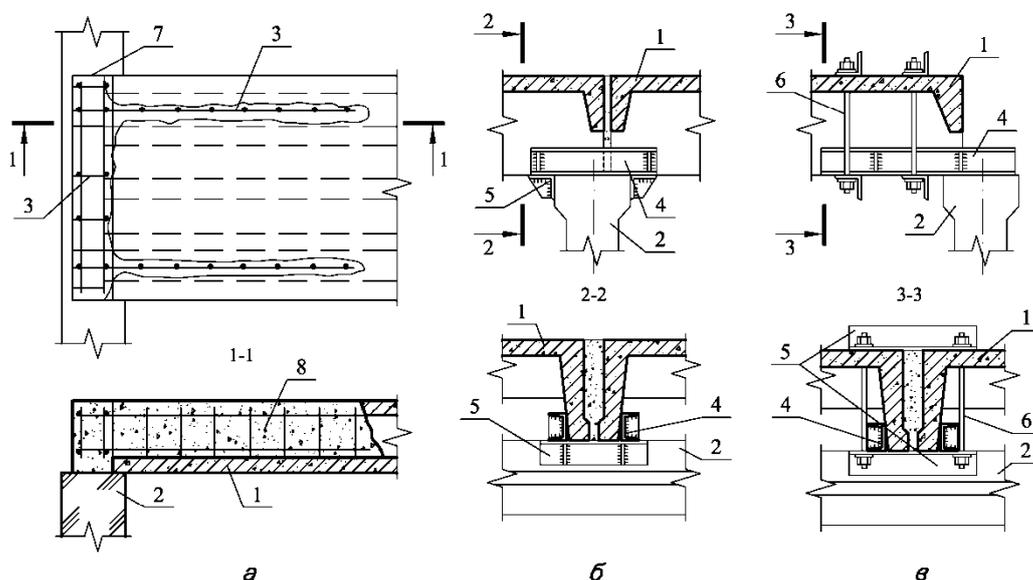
Усиление сборных железобетонных плит при недостаточном опирании: а – многопустотных плит на крайних опорах; б – ребристых на промежуточной опоре; в – ребристых на крайней опоре; 1 – усиливаемая плита; 2 – опора; 3 – дополнительные каркасы; 4 – швеллер; 5 – опорный уголок; 6 – болты анкера; 7 – анкерная балка; 8 – монолитный бетон; 9 – уголки анкера
